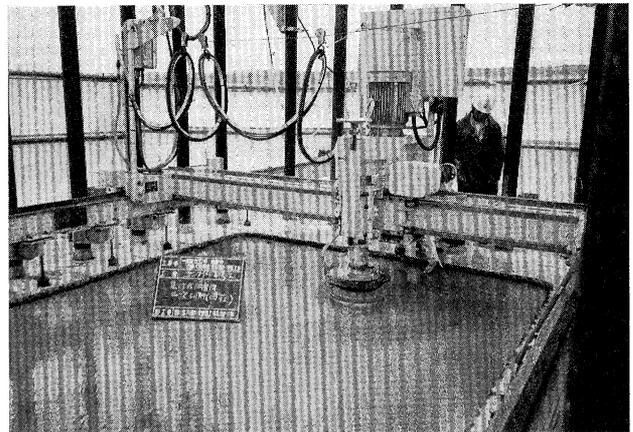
白鳥大橋塔基部コンクリート研磨状況
